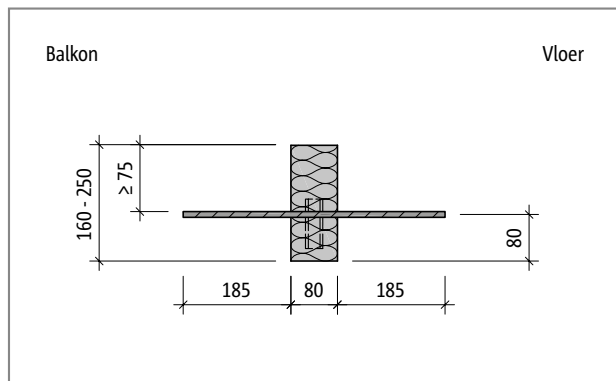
Schöck Isokorf® T type H-VV2-NN1: Zijaanzicht
